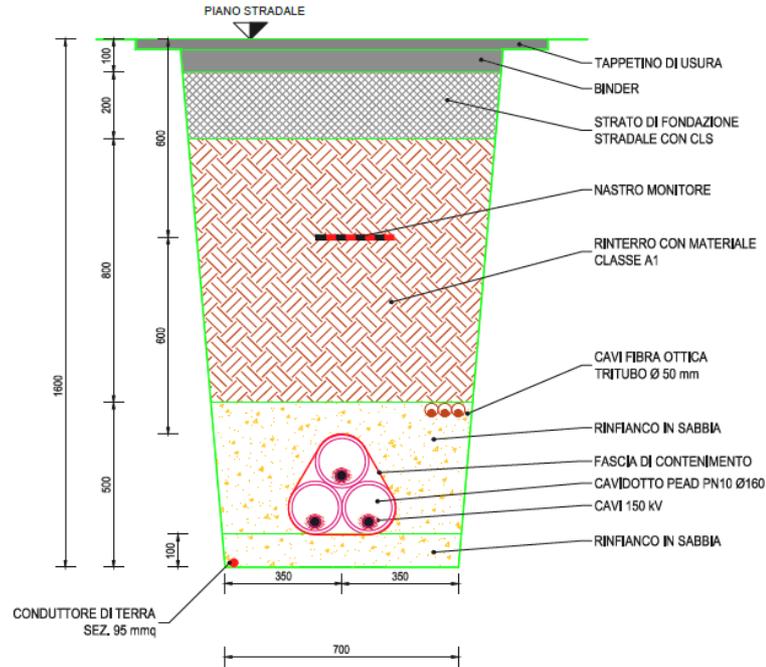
Sezione tipo cavidotto AT su strada asfaltata
